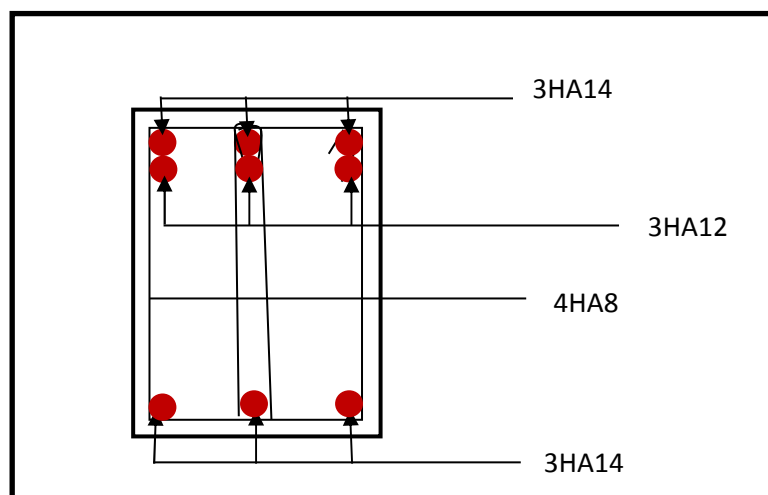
Ferrailage aux appuis d'une poutre principale.
